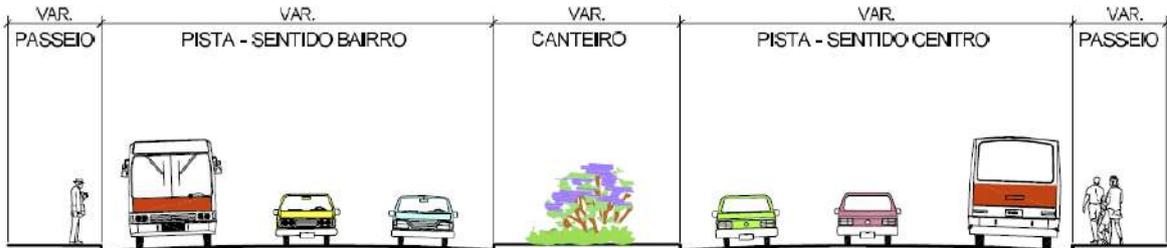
Seção existente atualmente com três faixas por sentido e canteiro central existente na Avenida Jorge Amado.
